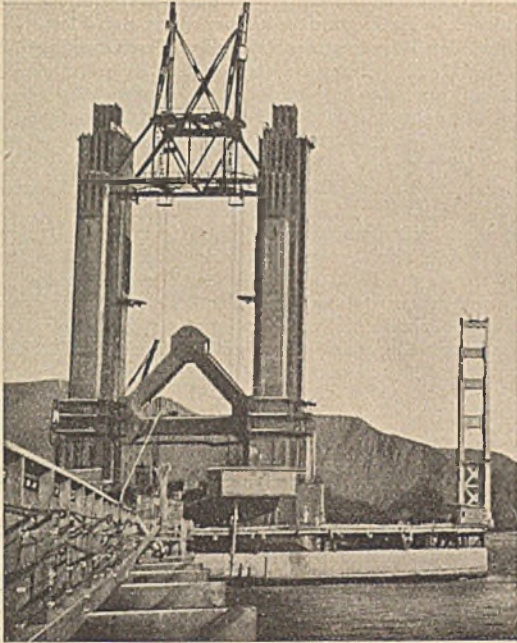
Aufstellung der Pylone mit den Kletterderricks.
